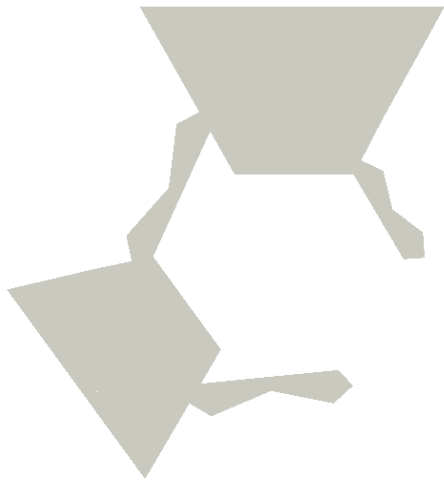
Modelo alámbrico de la losa de la planta tipo (Architrave)
